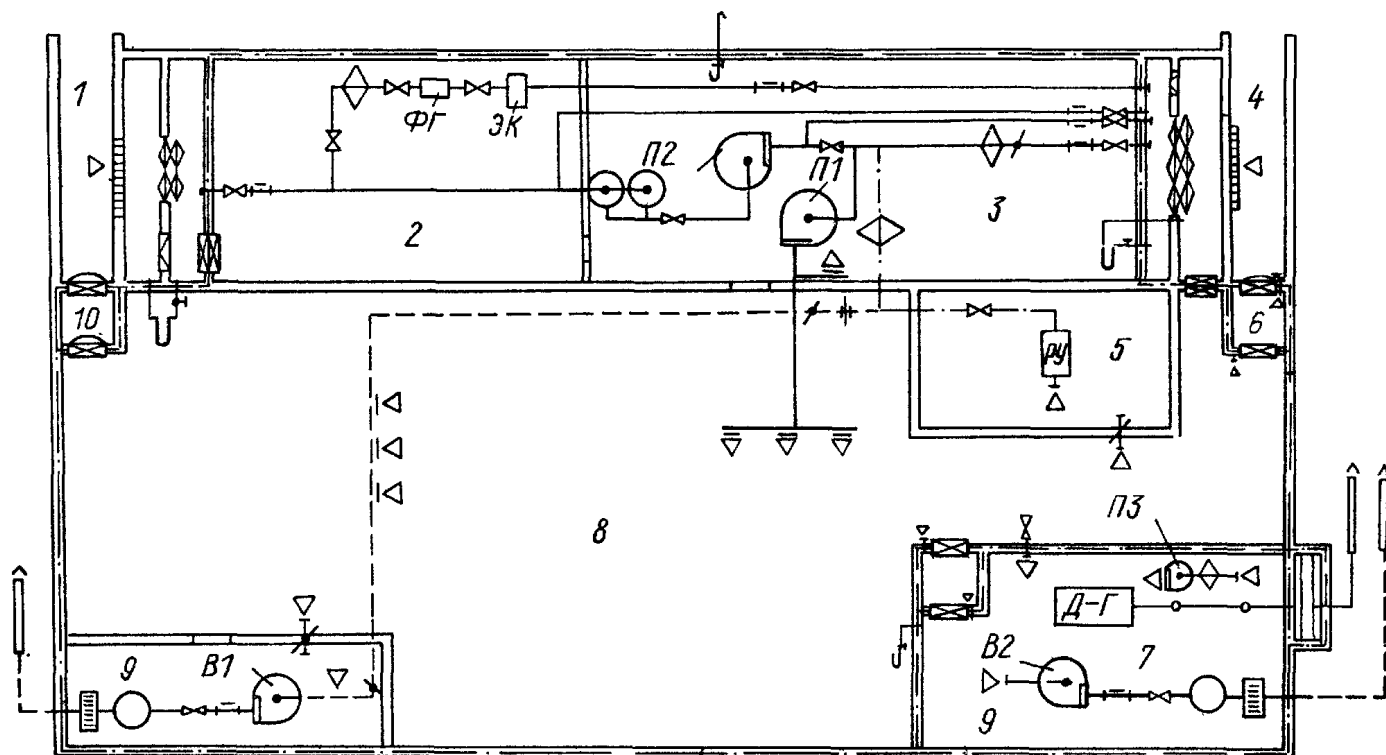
Принципиальная схема вентиляции убежища, оборудованного вентиляторами с электрическим приводом для режимов вентиляции I, II и III
